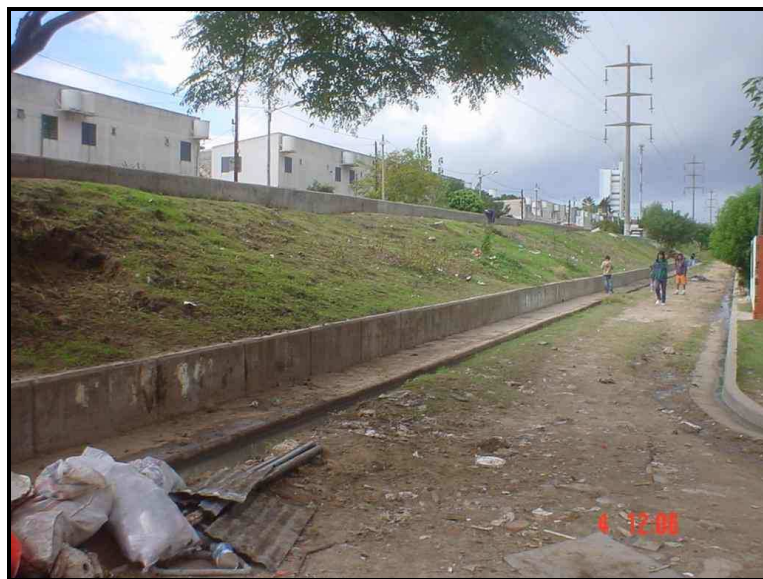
Vista del barrio de viviendas desde la calle perimetral a La Cava
